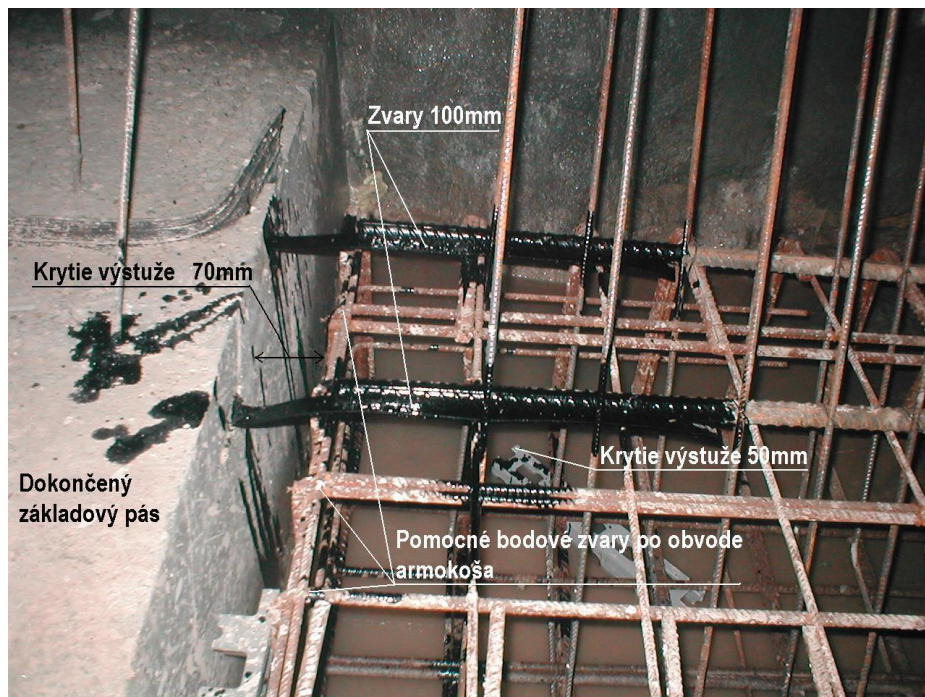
Príklad zvarenia armokoša základovej pätky a pilót
